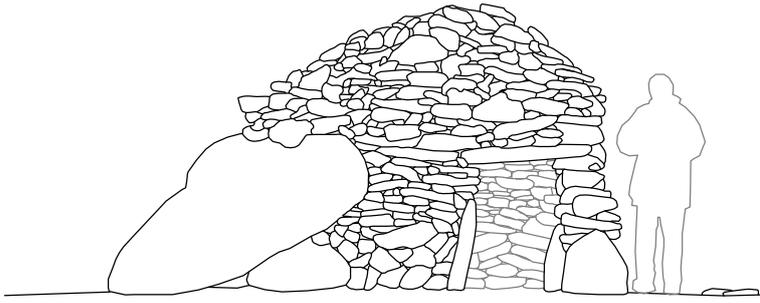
Alzado del casal de Vallancho en Bermillo de Sayago. Fuente: Elaboración propia.
